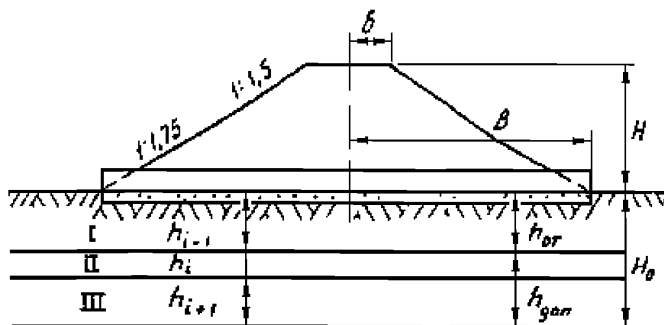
Схема к расчету осадок труб на оттаивающих грунтах
